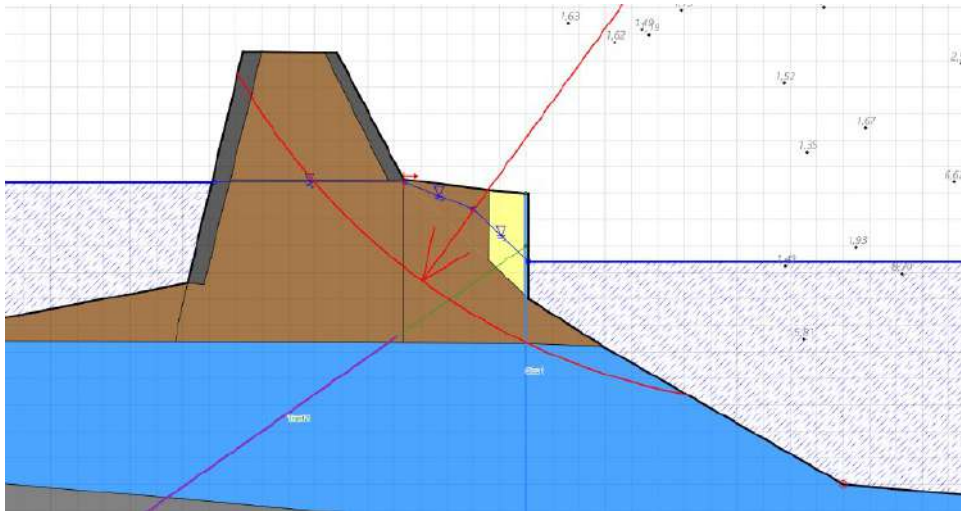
Coupe de calcul du site état projeté (Fondasol).
